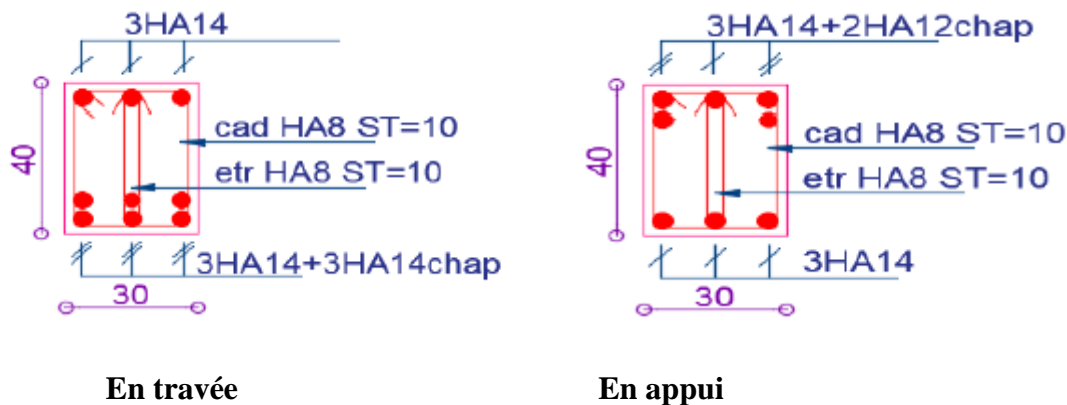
Détaille schéma de ferrailage de la poutre palière
